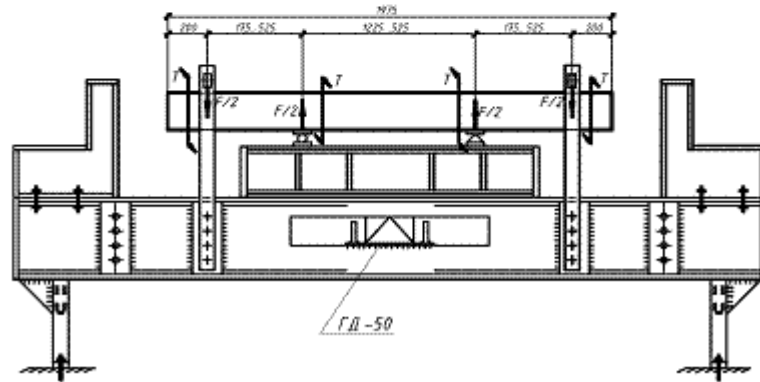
Универсальная силовая установка для испытания опытных балок на поперечный изгиб с кручением.
